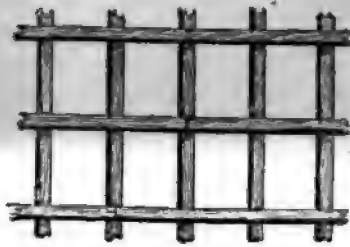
Plan des poutrelles et plan des pilotis de la marière de Castione.
